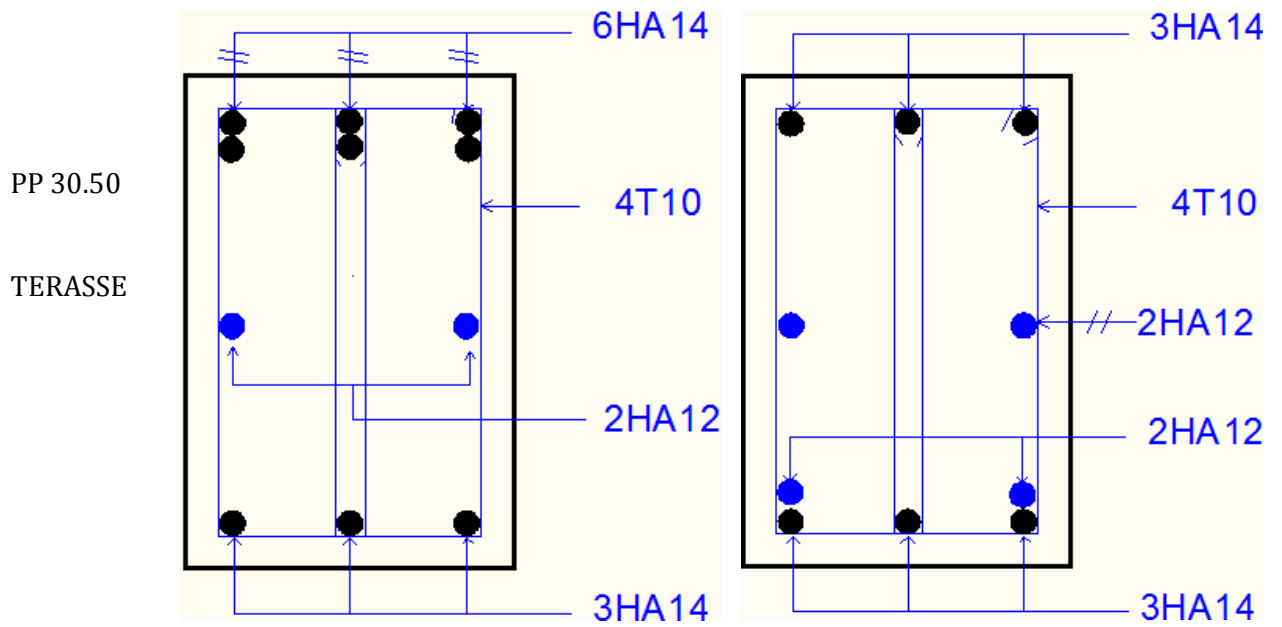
Section de ferrailage des poutres principales terrasse30.50.
